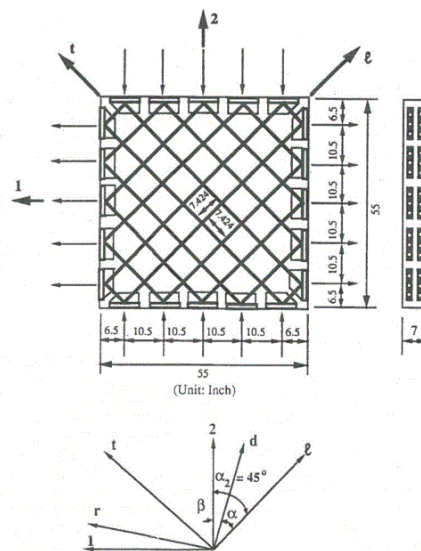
Características das placas ensaiadas por Pang e Hsu [13].
